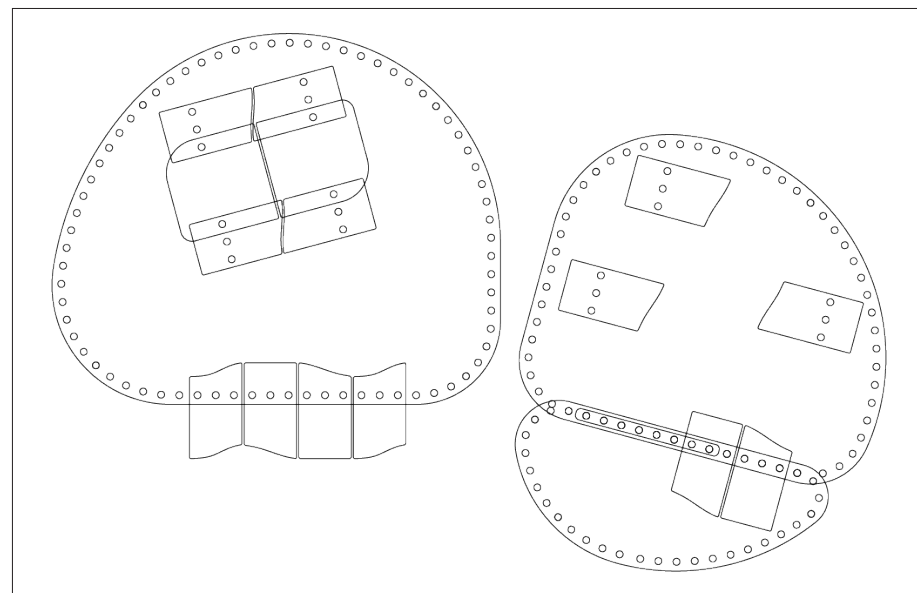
Planta de la propuesta que ocupa 34m² aproximadamente.
